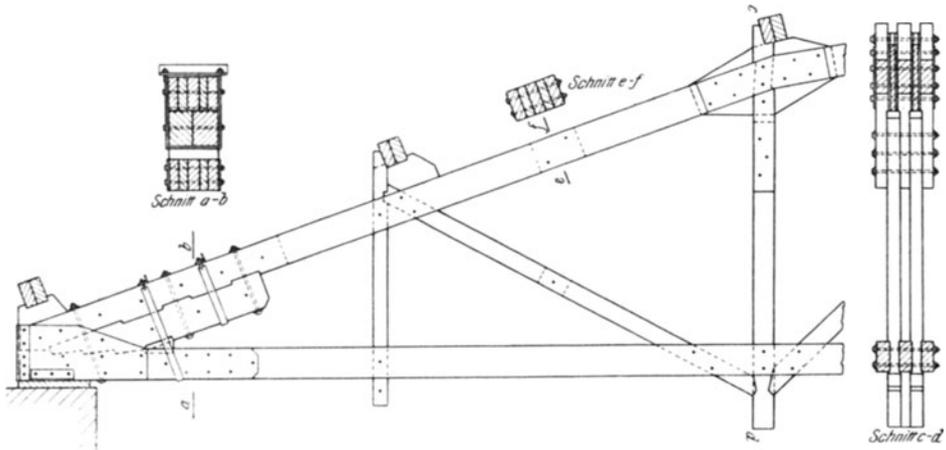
Auflagerpunkt eines Fachwerksträgers.
